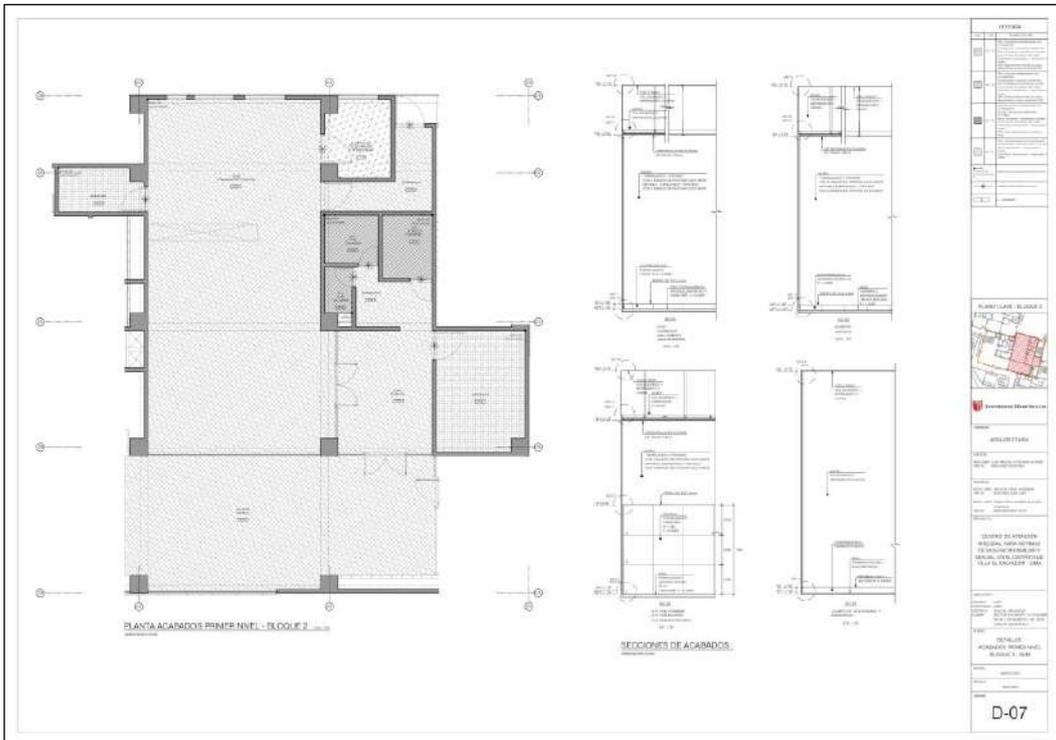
Plano de acabados en zona SUM primer nivel – bloque 2.
